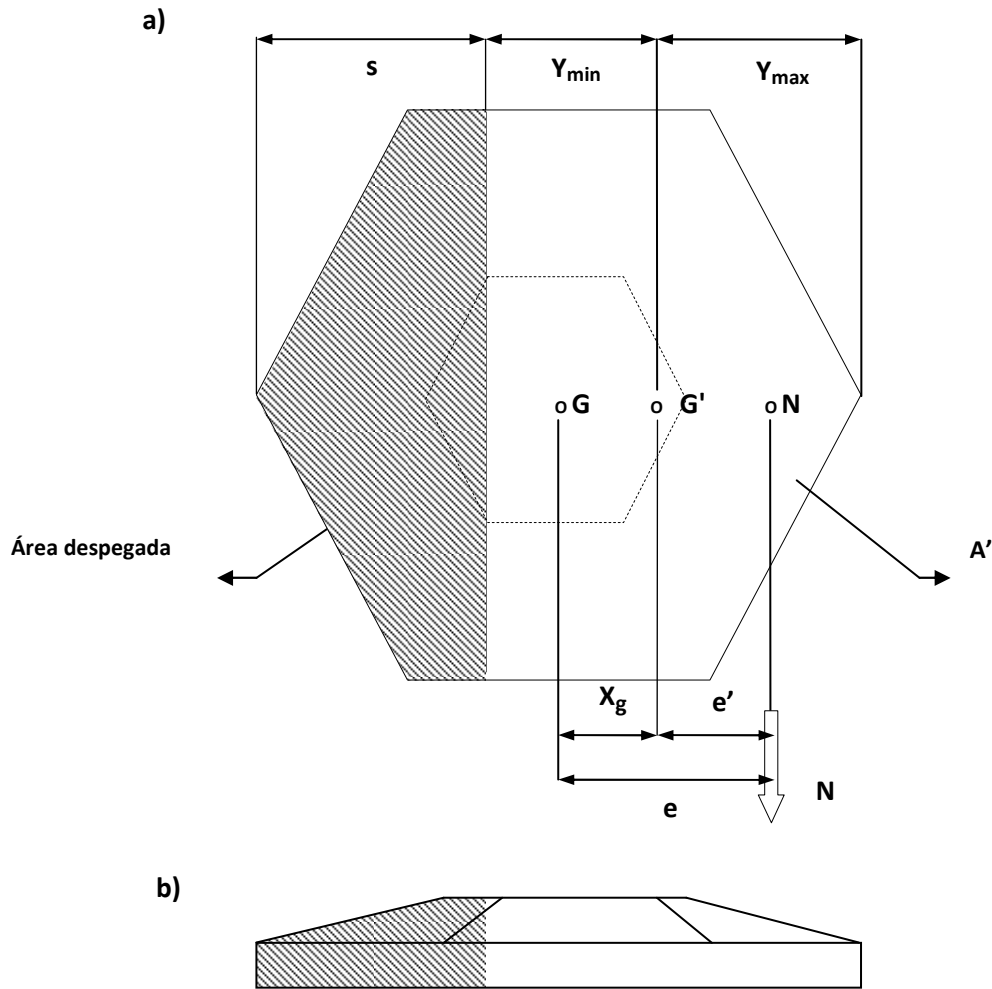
a) vista inferior de la zapata, b) vista en alzado.
